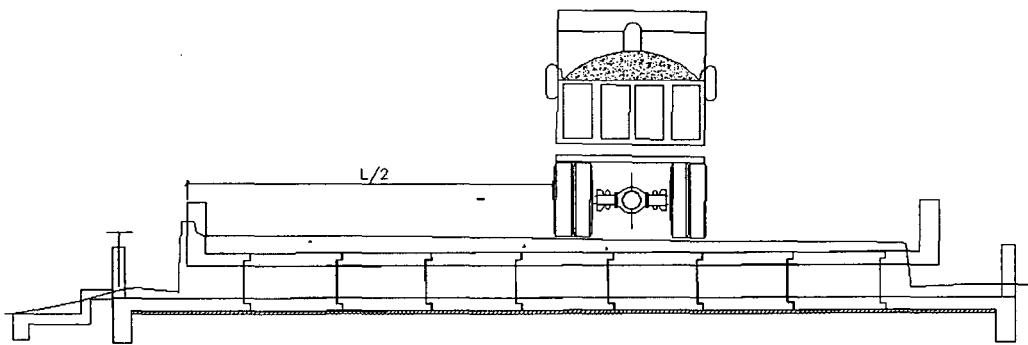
Vista en elevación del camión para la prueba de junta con carga en el centro de alcantarilla
